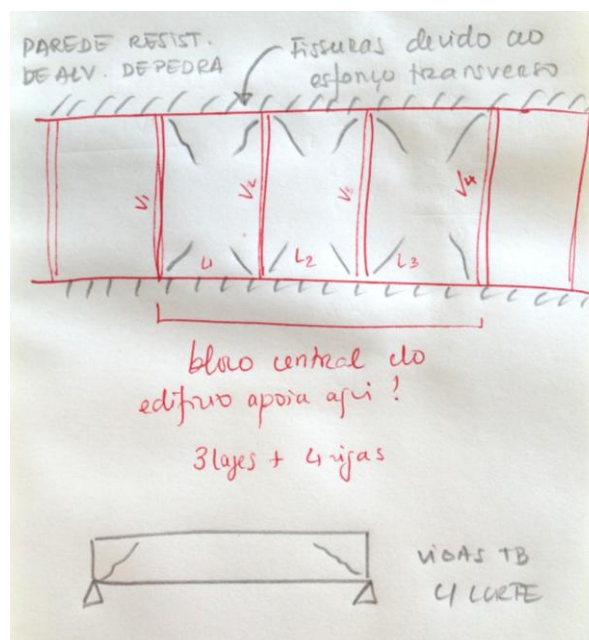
Esquema dos danos detetados nas lajes e nas vigas
